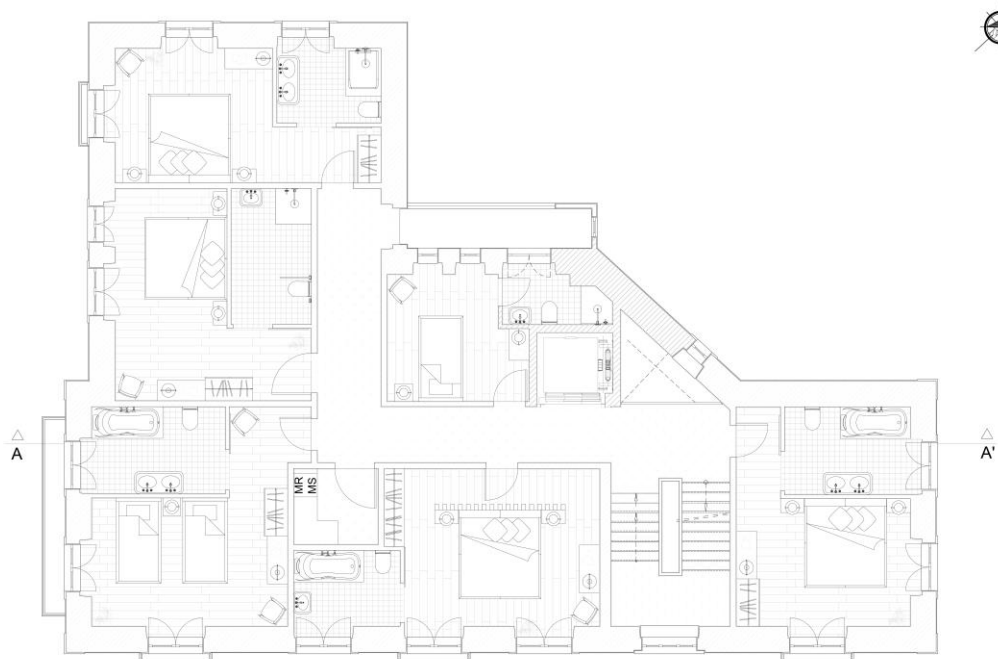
Planta de Apresentação Piso 1. Fonte: Autor
